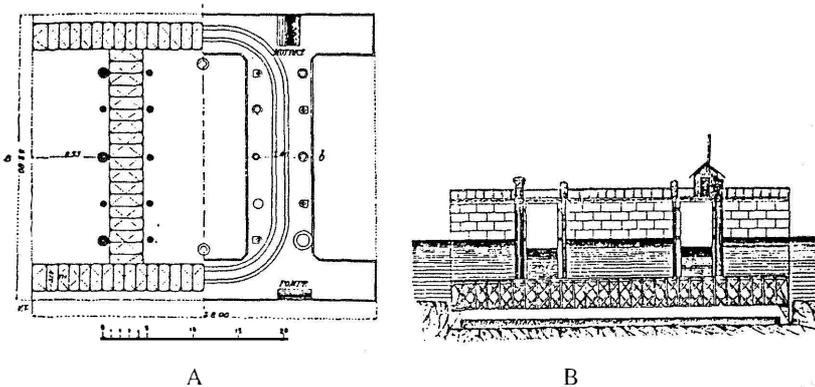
A: pianta del cassone galleggiante; B: sezione del cassone galleggiante.
